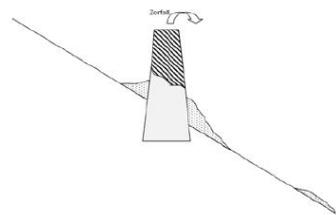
Rückgebaute Steinmauer gegen Lawinen.
